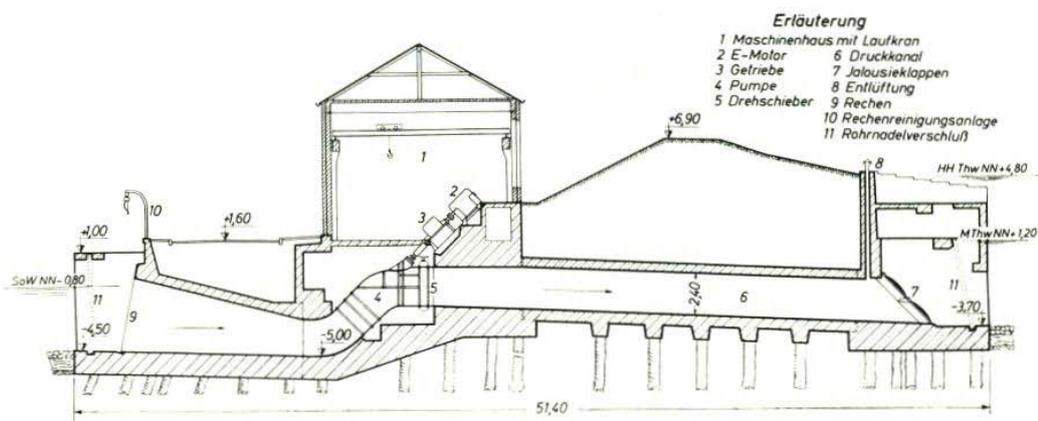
Längsschnitt des Pumpenlaufes Leybuchtziel mit schrägliegender Pumpenaggregat
